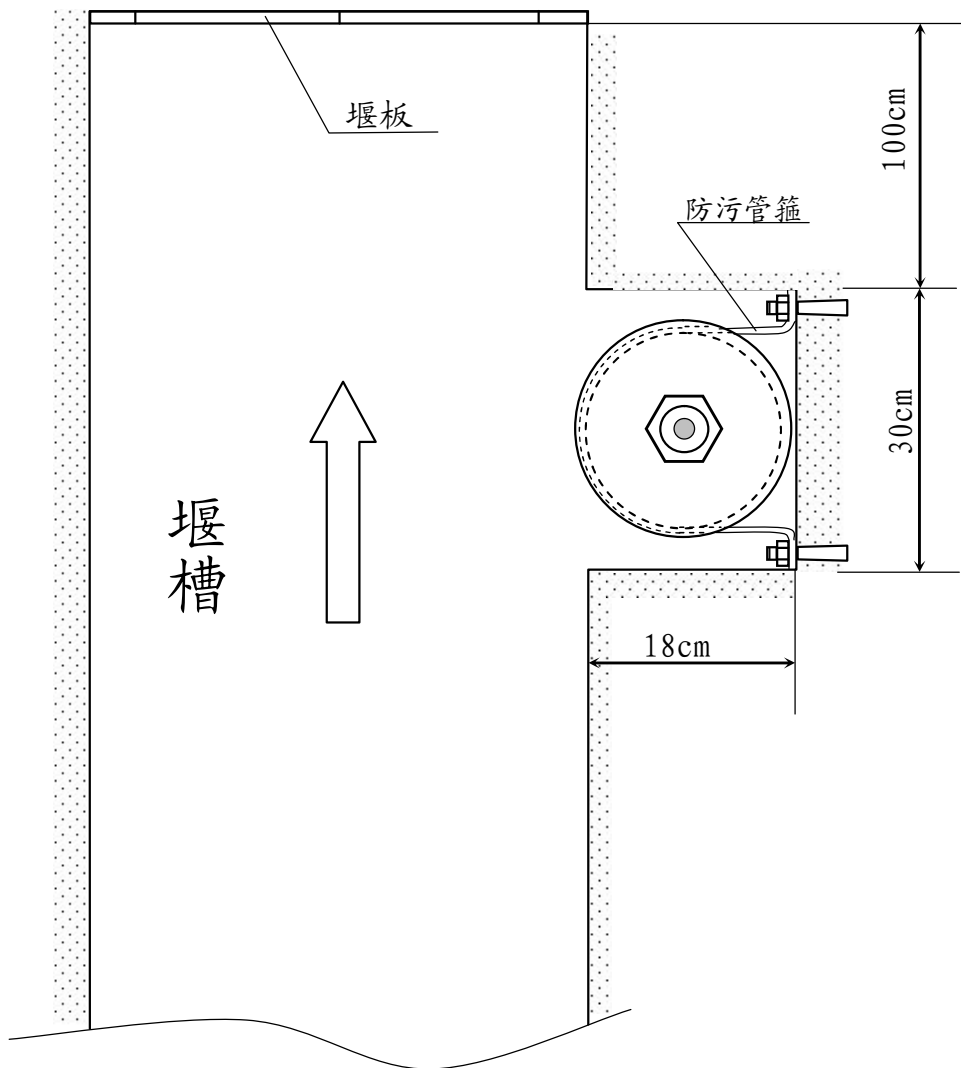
BSIL-W10 堰流（水位）计安装平面图（槽式安装，立面图略）
